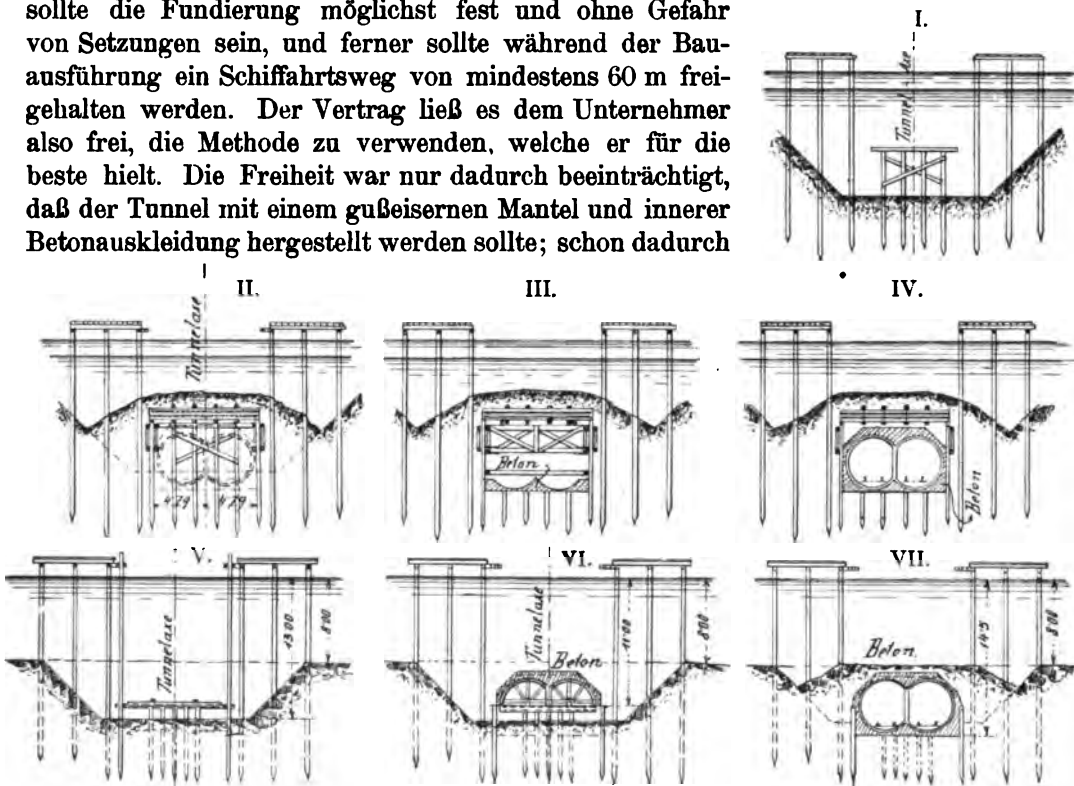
Baustadien während der Ausführung des Harlem River-Tunnels.
